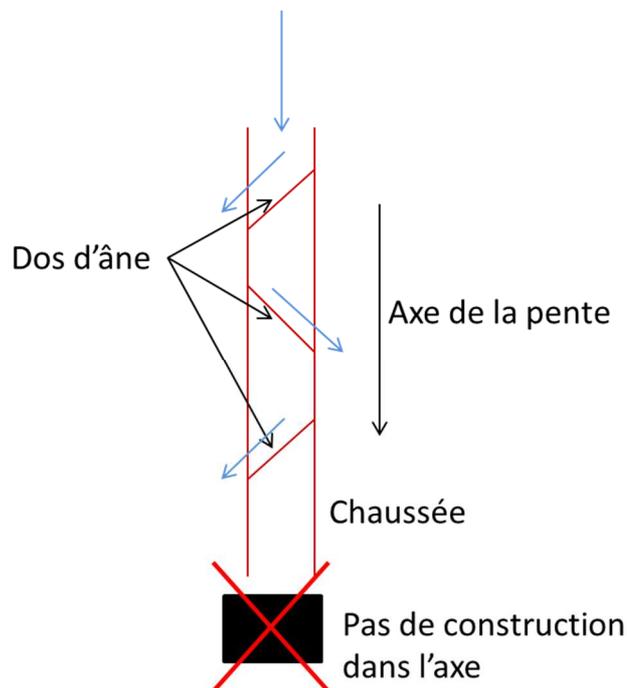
Exemple de chaussée dans l'axe de la pente
